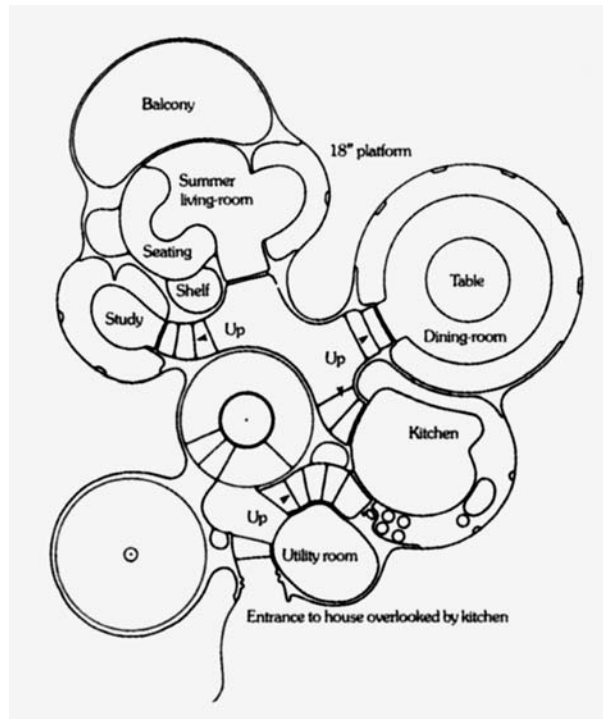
Roger Dean, Wohnhaus, Entwurf 1966. Grundriss.
